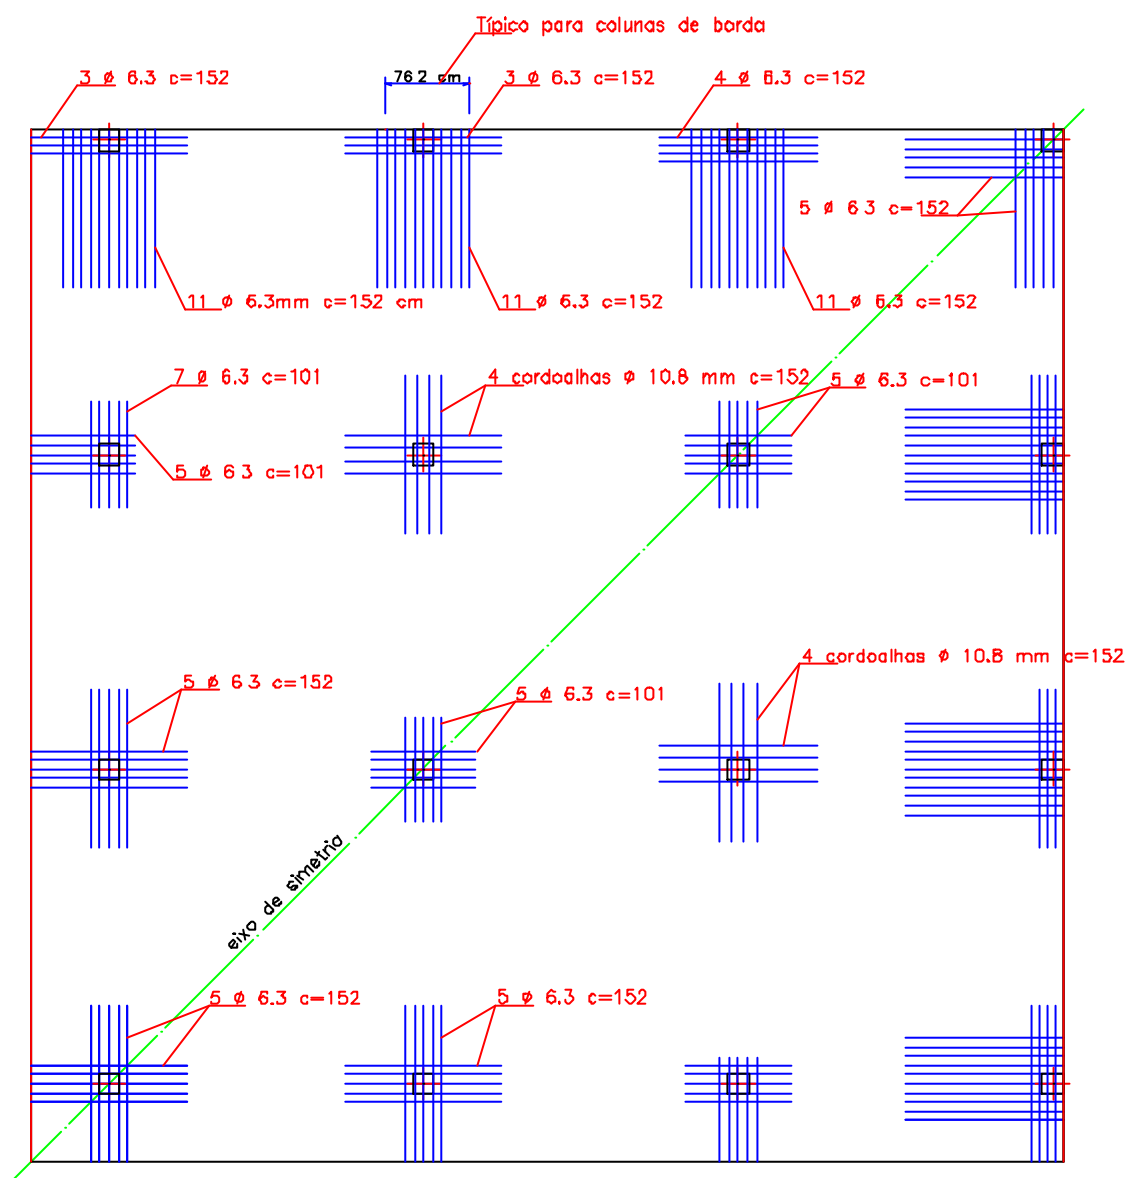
Armadura Aderente na Laje II – 1975
